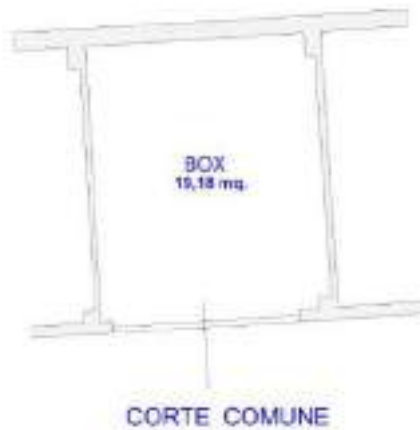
Confronto planimetrie stato di fatto e planimetrie catastali
